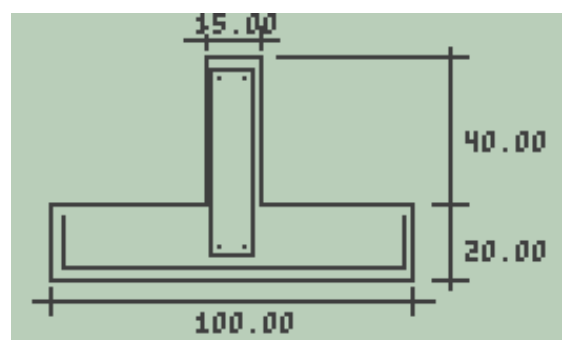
Sapata corrida com viga de rigidez - Detalhamento da seção transversal.
